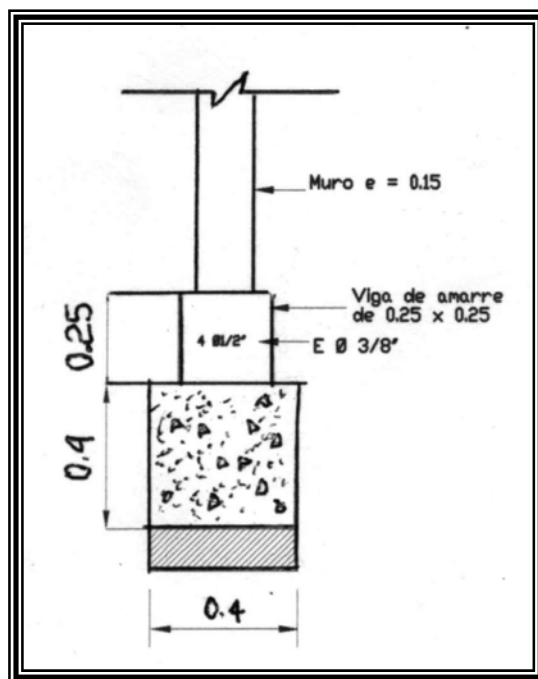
Dimensiones de ciclópeo y viga de cimentación
